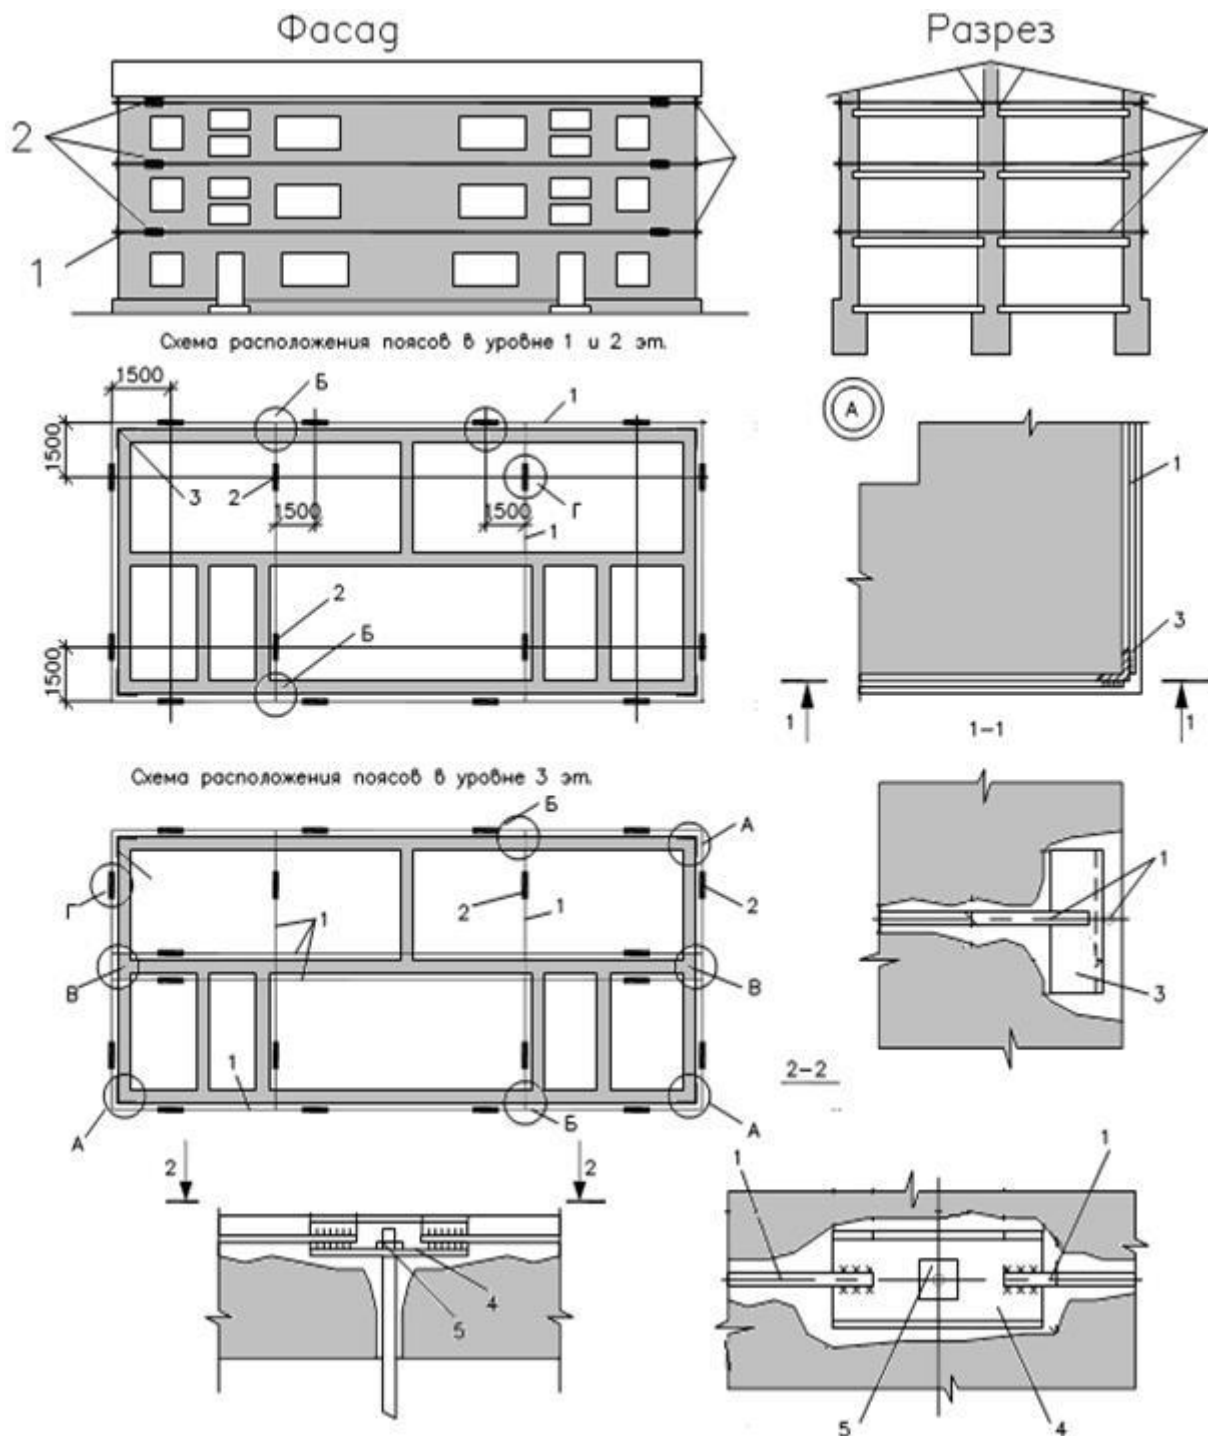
Усиление здания стальными предварительно напряженными поясами:
